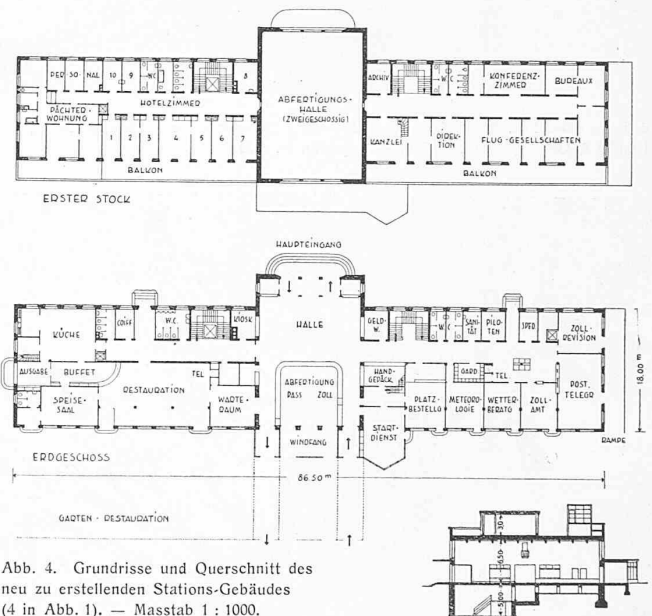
Grundrisse und Querschnitt des neu zu erstellenden Stations-Gebäudes (4 in Abb. 1). — Masstab 1 : 1000.
